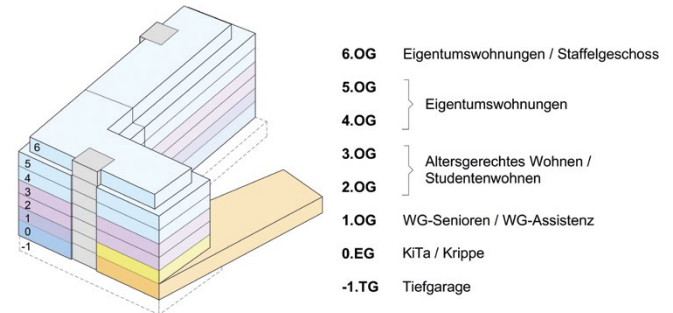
Gebäude Wendenschloßstraße 47 (Grafik: blfp planungs gmbh 2021)
